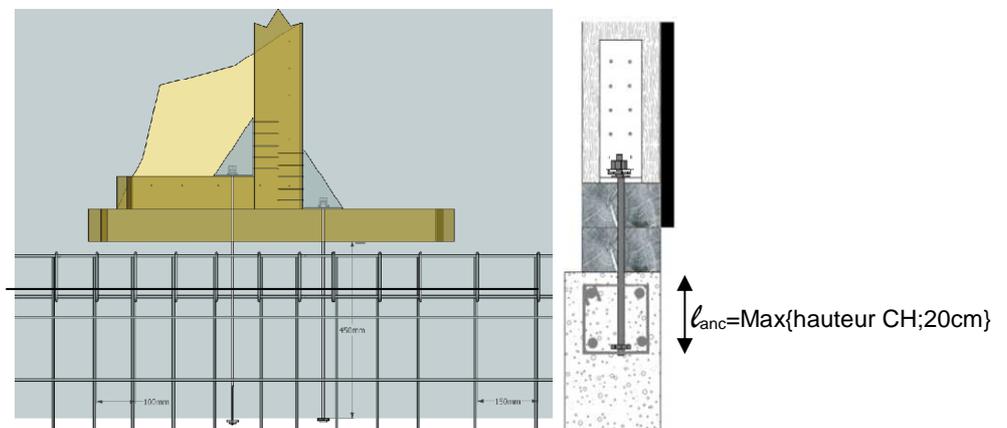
Schémas de principe d'ancrage d'un panneau VT par tige d'ancrage dans une réservation dans la fondation
